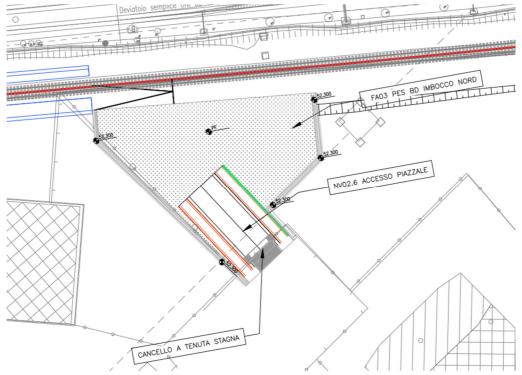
PLANIMETRIA DI PROGETTO FA03
